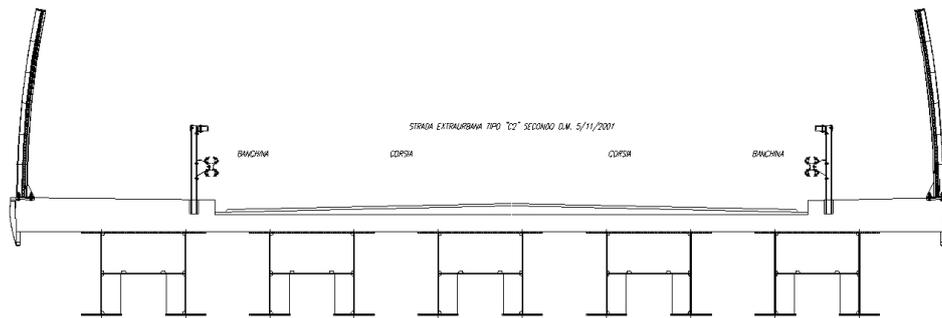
Sezione trasversale del nuovo sovrappasso n. 69
